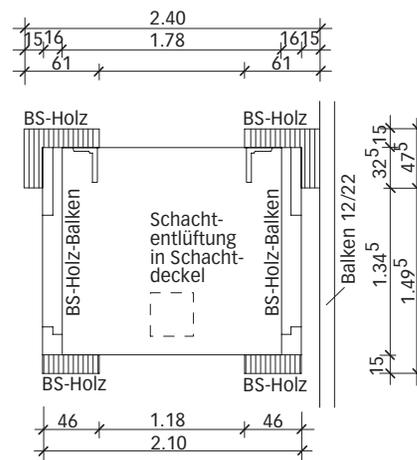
Grundriss des BS-Holz-Schachtgerüsts
